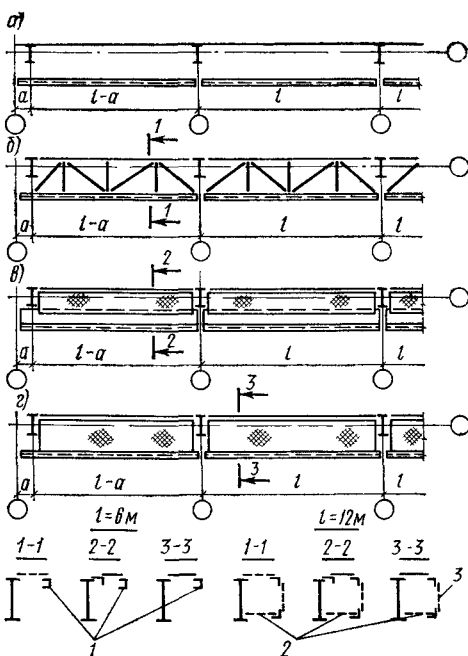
Подкрановые конструкции по крайним рядам колонны
